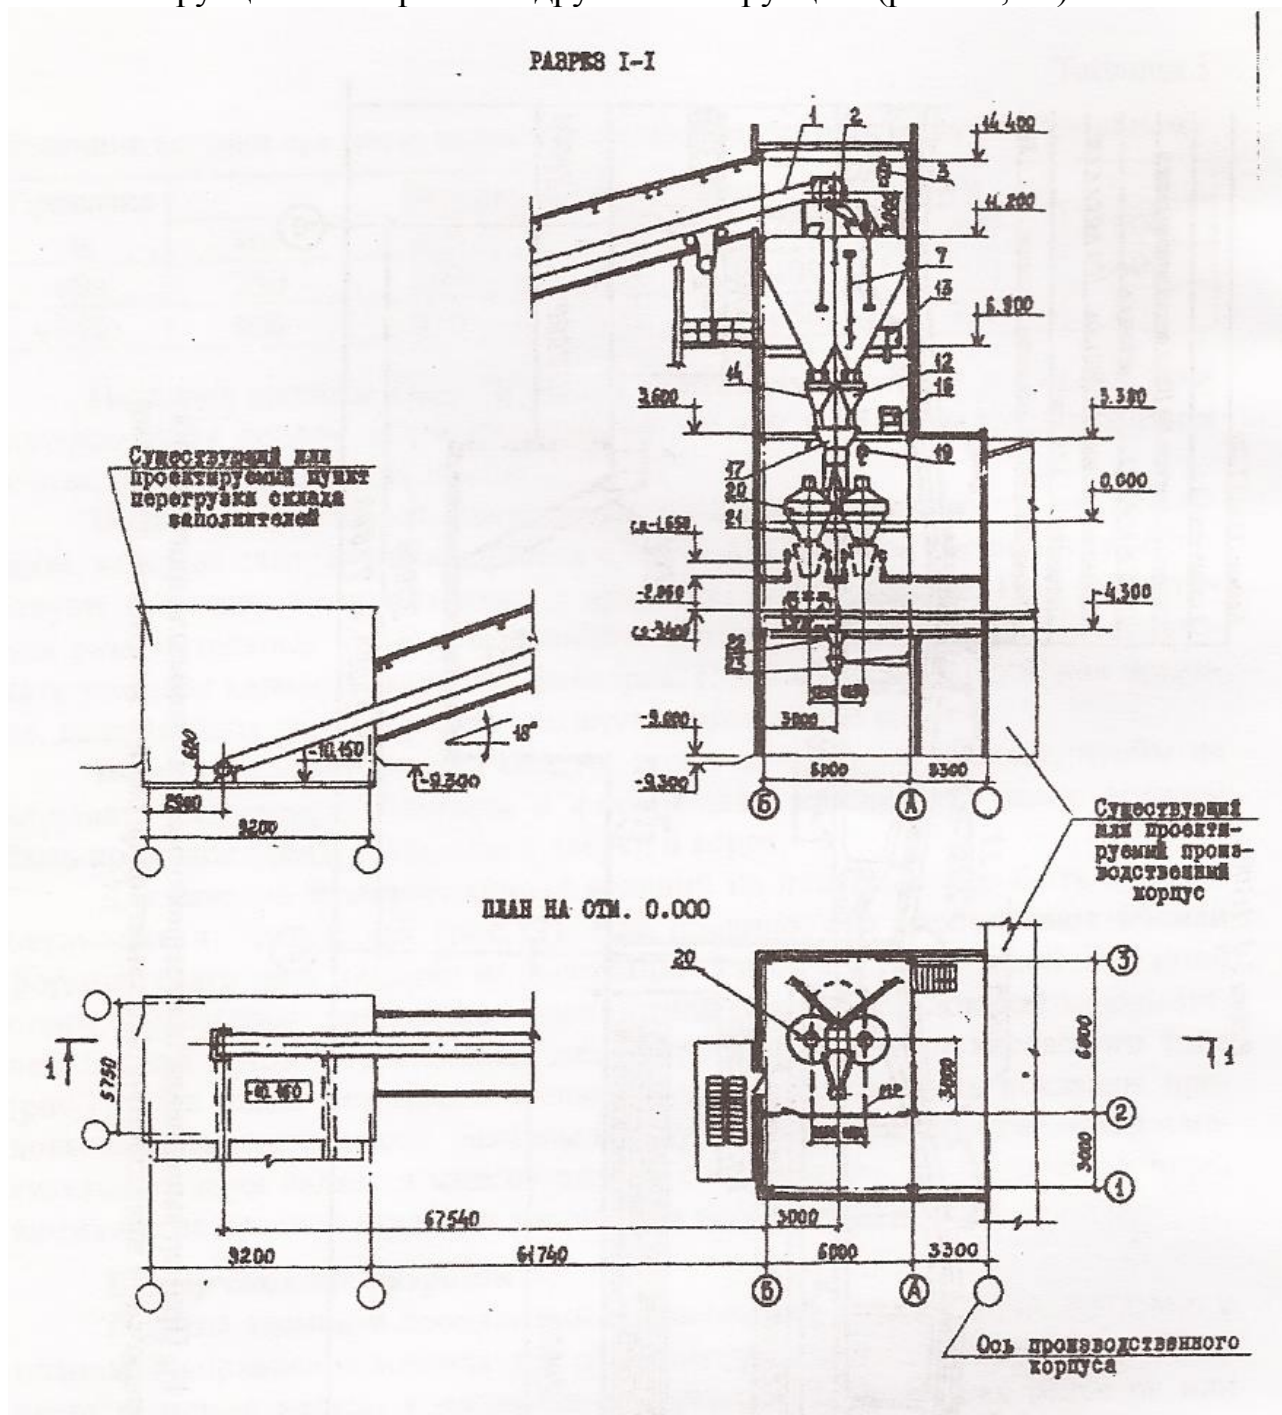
Пример выполнения плана и разреза бетоносмесительного узла завода железобетонных изделий
